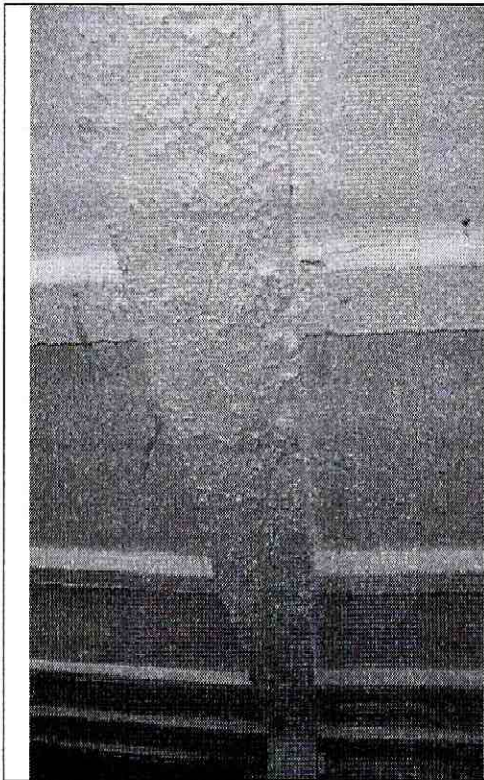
Vista de la cara inferior de la viga del tercer nivel a la que se le eliminó el muro sobre el cual se apoyaba.
